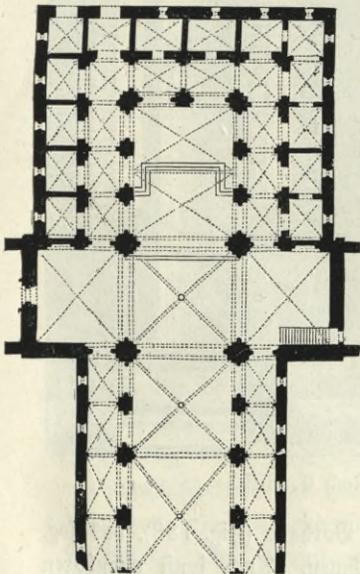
Kirche zu Riddagshausen. Grundriß.
